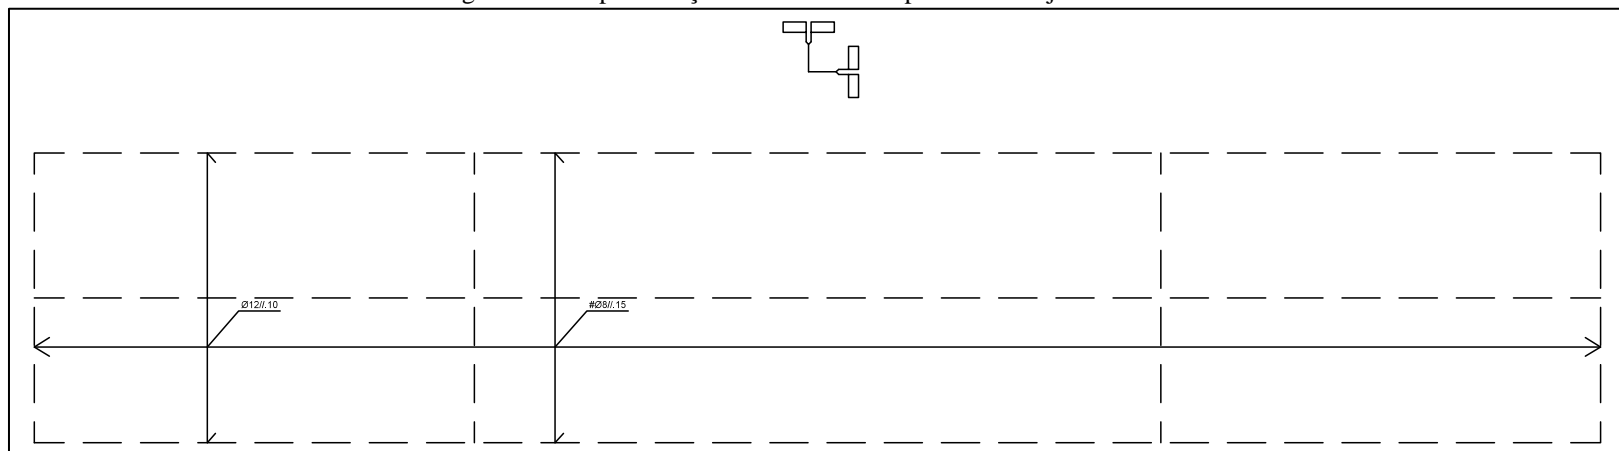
Representação de armaduras inferiores na laje de tabuleiro
